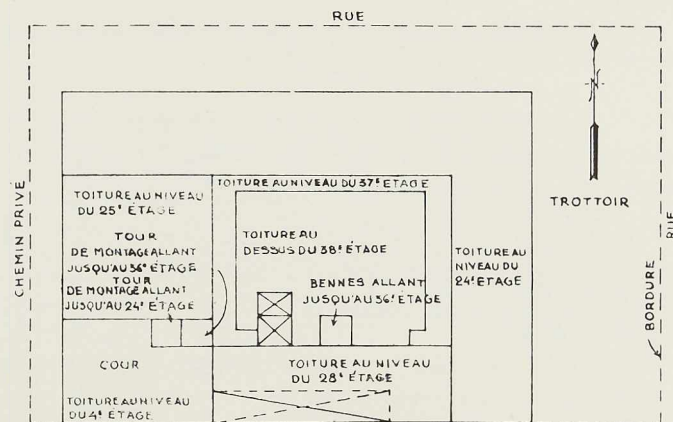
Bâtiment de 38 étages. Vue en plan des toitures montrant les emplacements des tours de montage.
